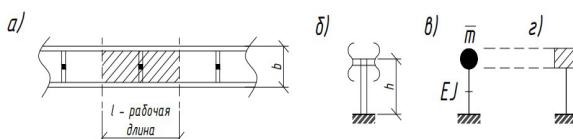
К разработке динамических расчетных схем опорных стен.
